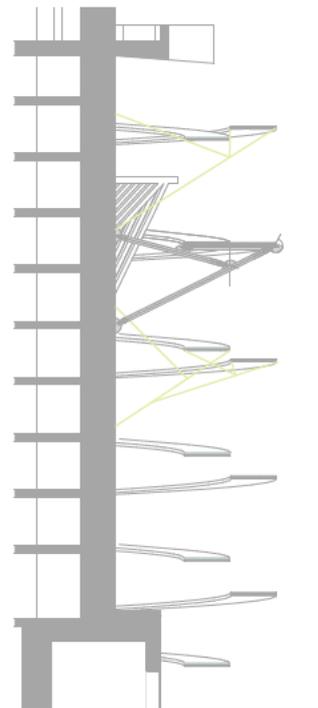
Fassadenschnitt, Konstruktion der Rampe, Skizze 2
